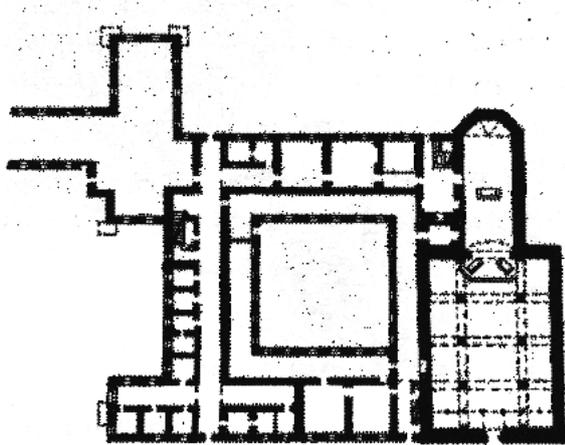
Benediktinerkonvent, Grundriss, Lwiw.
